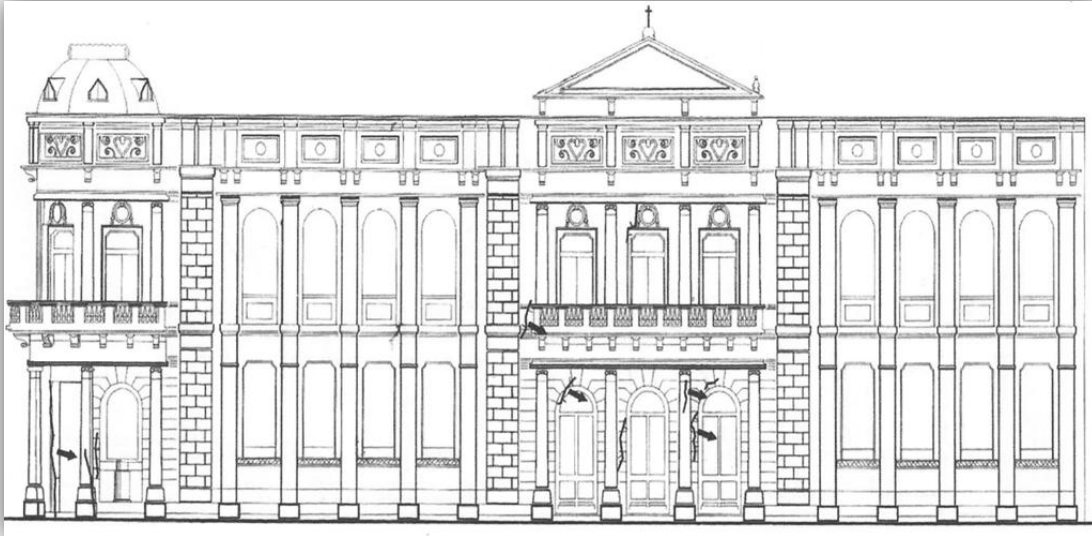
Levantamiento de grietas en fachada Oeste, (1995) [2.17].
